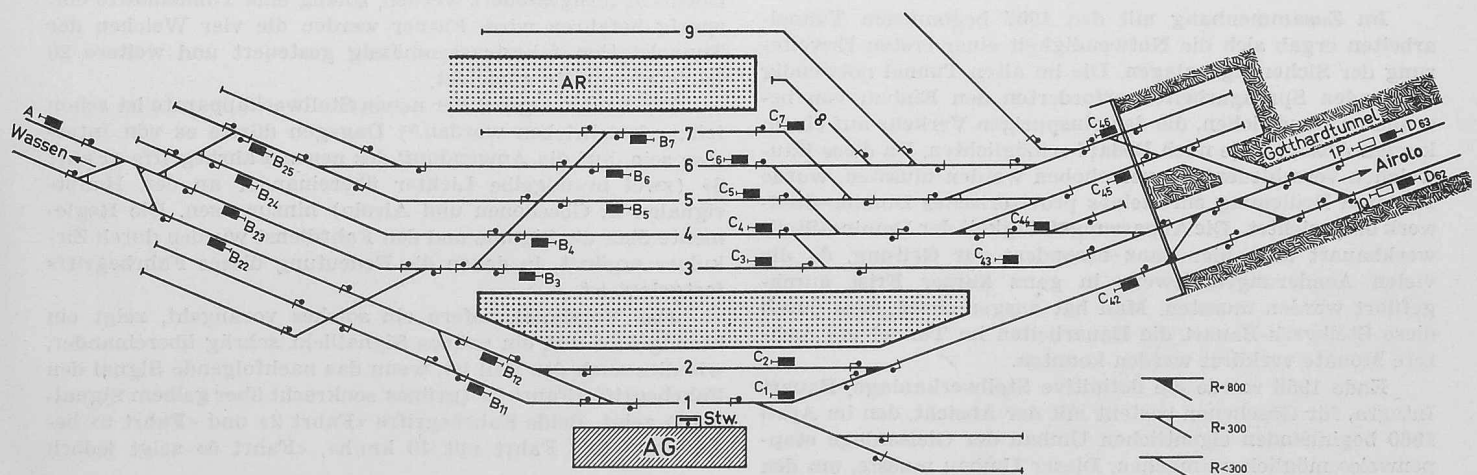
Situationsplan des Bahnhofs Göschenen nach dem Umbau. AG Aufnahmegebäude, AR Autoverladerampe
